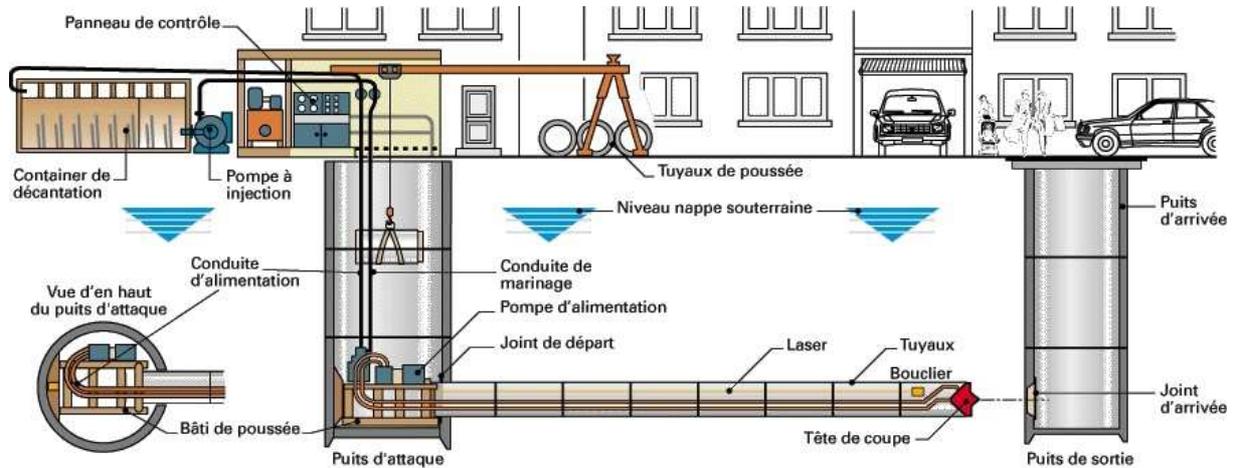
Schéma de principe d'un chantier de creusement par micro-tunnelier (source : <http://www.pentes-tunnels.eu> ; R-M Faure; M. Ghouari).
